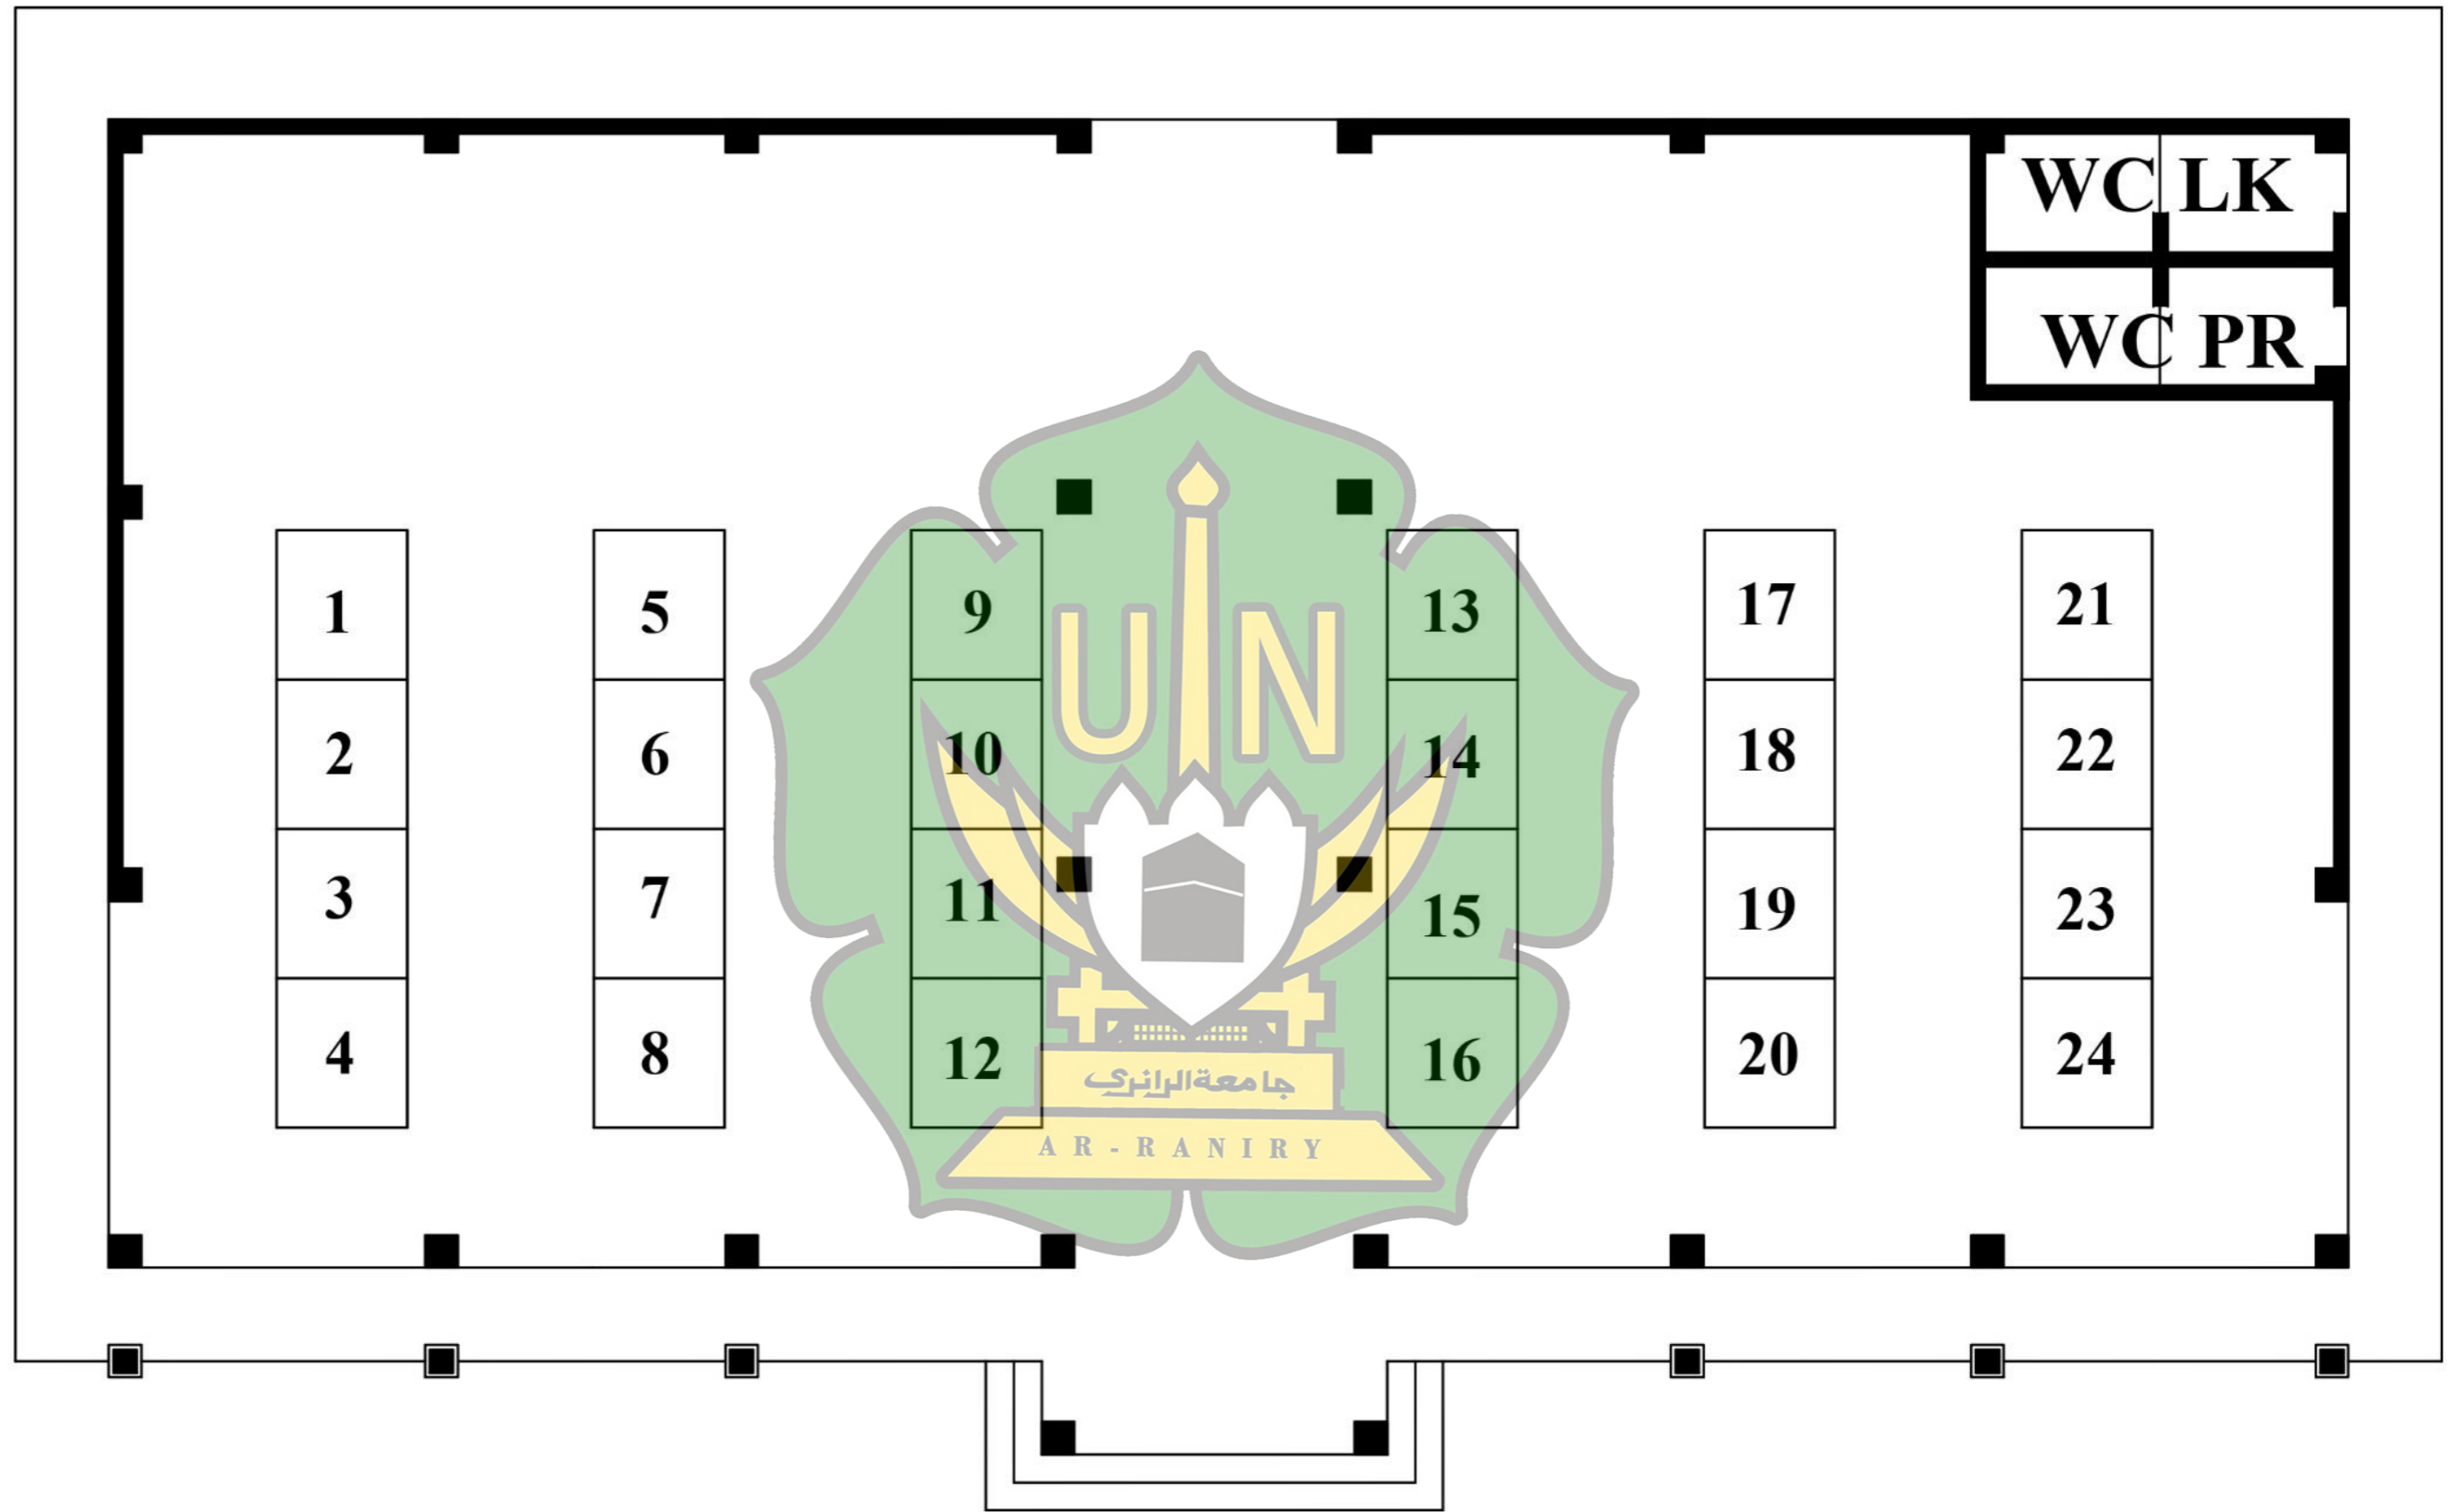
Denah Site Plan Pasar Al-Mahirah
